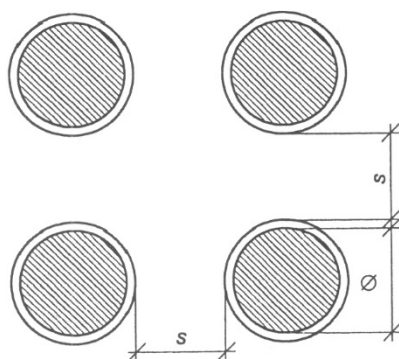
Rozmieszczenie zbrojenia w przekroju elementu żelbetowego
